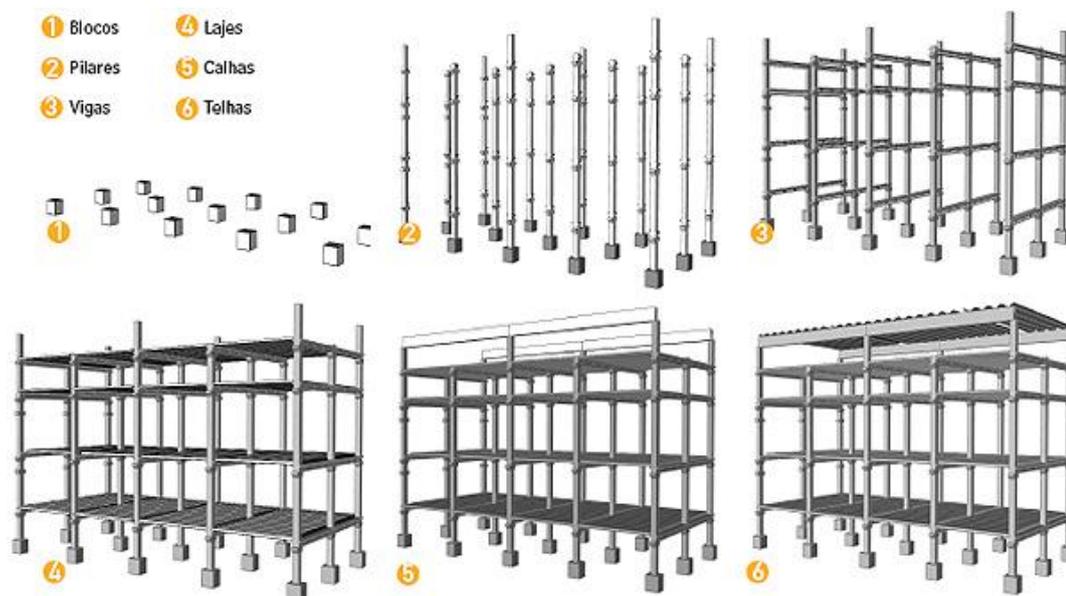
Elementos básicos da estrutura de pré-fabricado de concreto. Fonte: Revista Técnica edição 144, março/2009.
